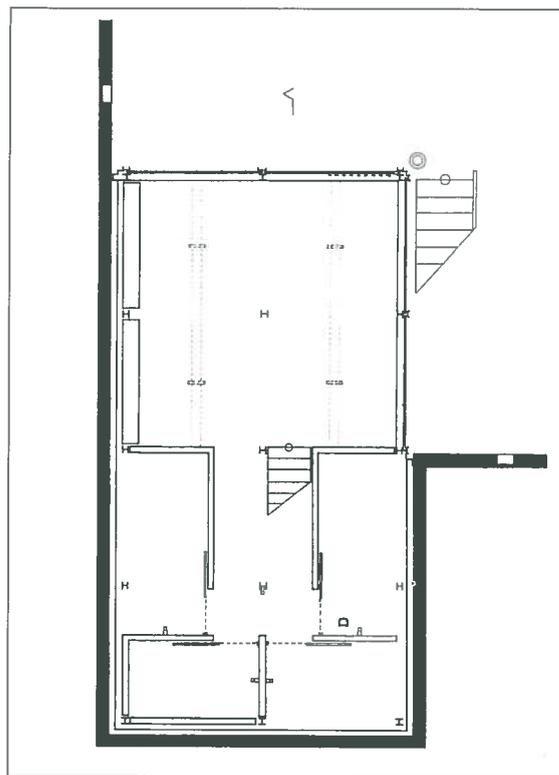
Pianta del piano terra: questo piano ospita le zone di servizio nella porzione parzialmente interrata e un locale adibito a studio che usufruisce dell'ampia vetrata rivolta a nord.
